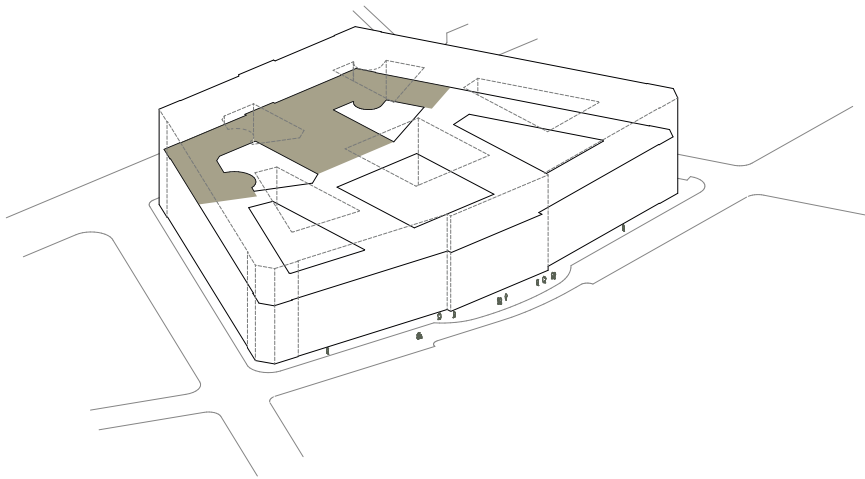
Bauliche Umbaumaßnahmen Grundriss Dachdraufsicht
